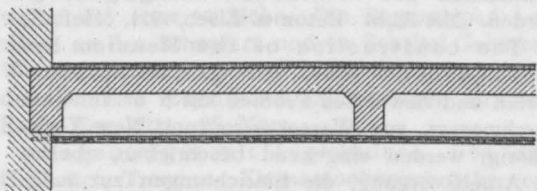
Sp.-K.-Decke unter Eisenbetondecke.
